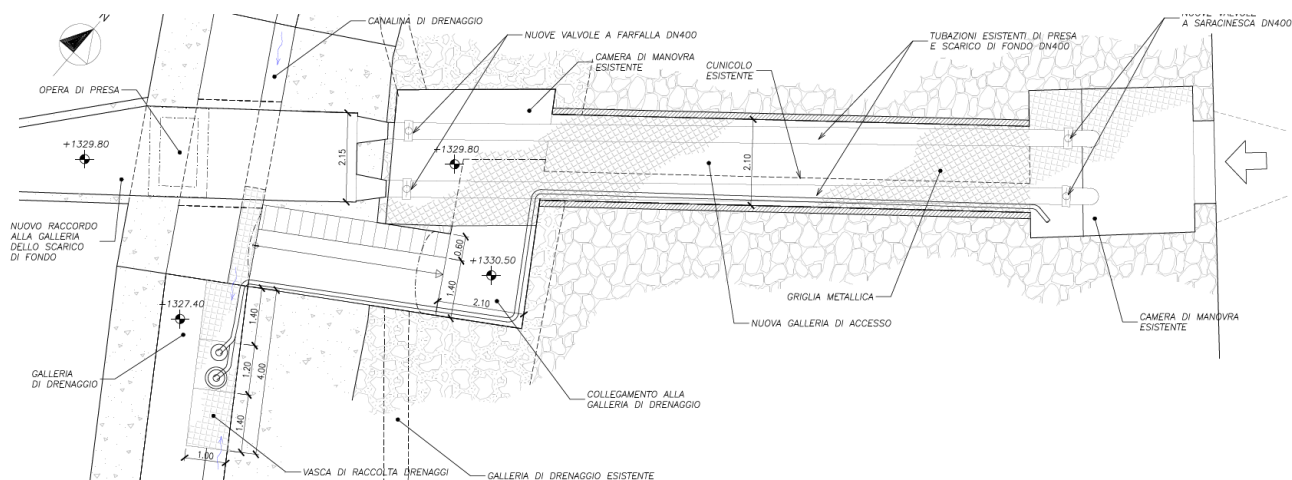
Planimetria dello scarico di fondo e opera di presa
